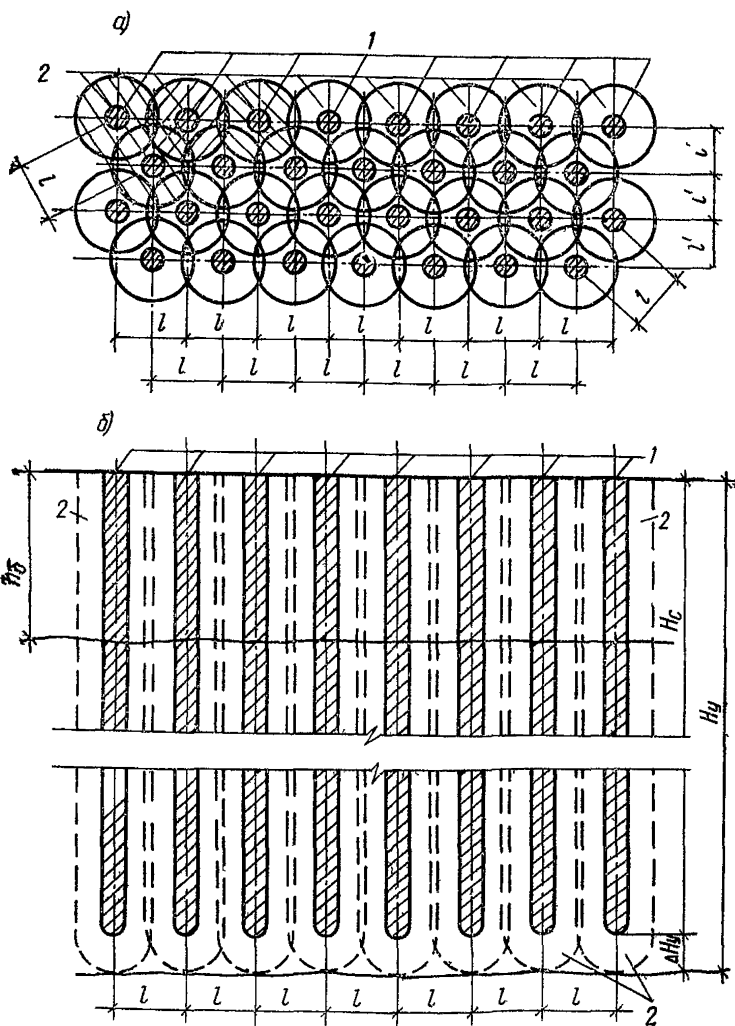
План расположения грунтовых свай (а) и поперечный разрез уплотненного массива (б)
